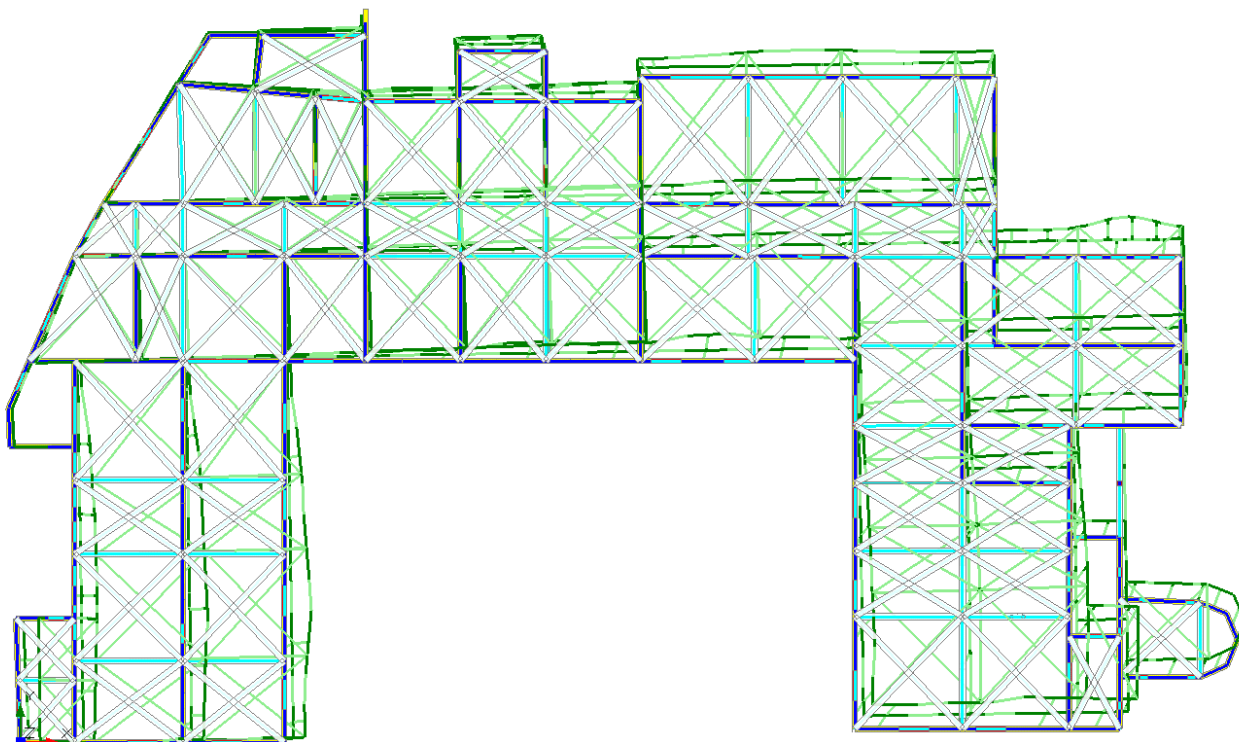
Deformata in pianta e prospetto del modo principale di vibrare in direzione Y
